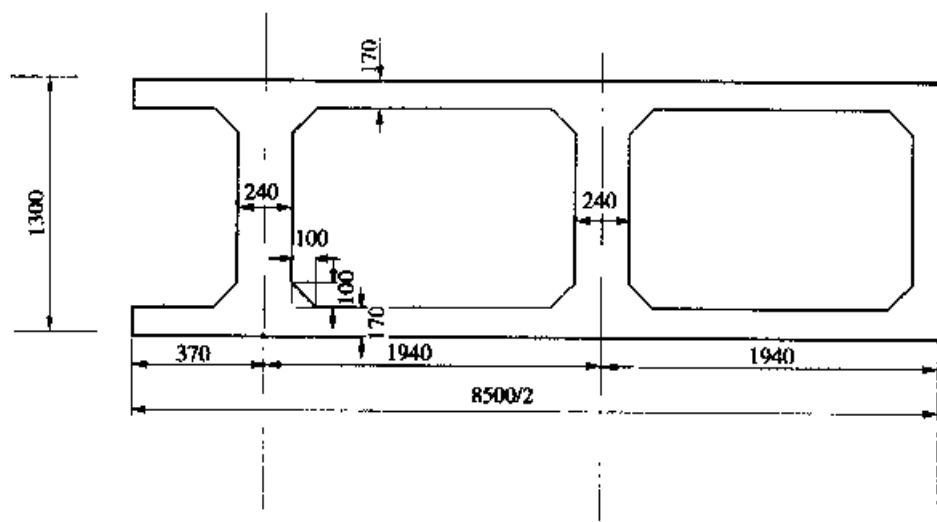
钢筋混凝土箱形拱截面尺寸(尺寸单位:mm)
